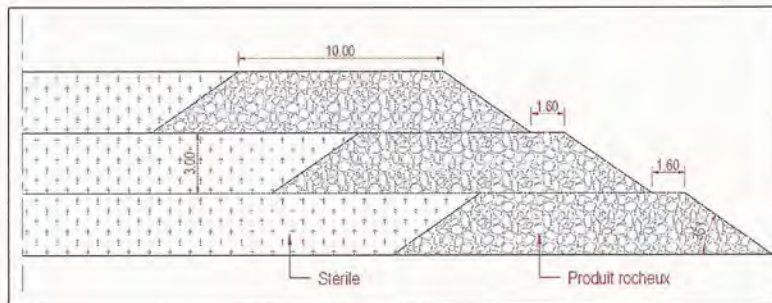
Schéma conceptuel pour la construction d'un niveau de 9 m
